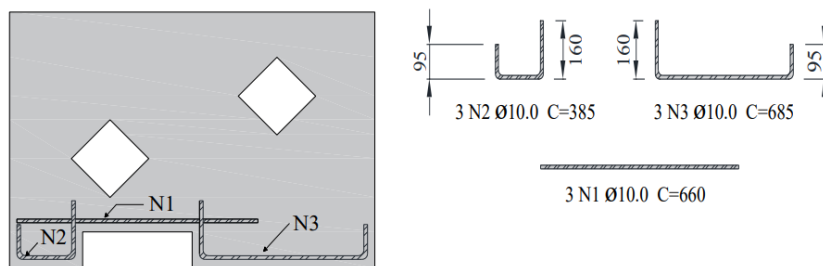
Detalhamento das armaduras DB-NR-H2-NA (dimensões em mm). Neta (2019).
